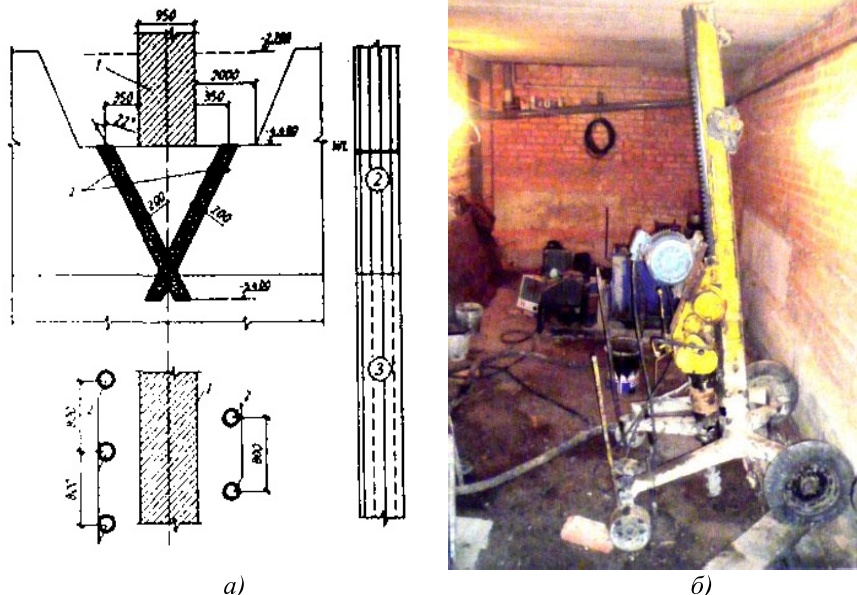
Схема закріплення ґрунтової основи під стрічковим фундаментом похилими ґрунтоцементними елементами – а), та малогабаритний буровий станок УЗБ-12 в підвалі будівлі, яку реконструюють – б).
